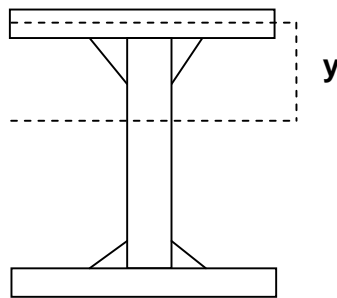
Fuerza cortante en soldaduras de filete [9].
